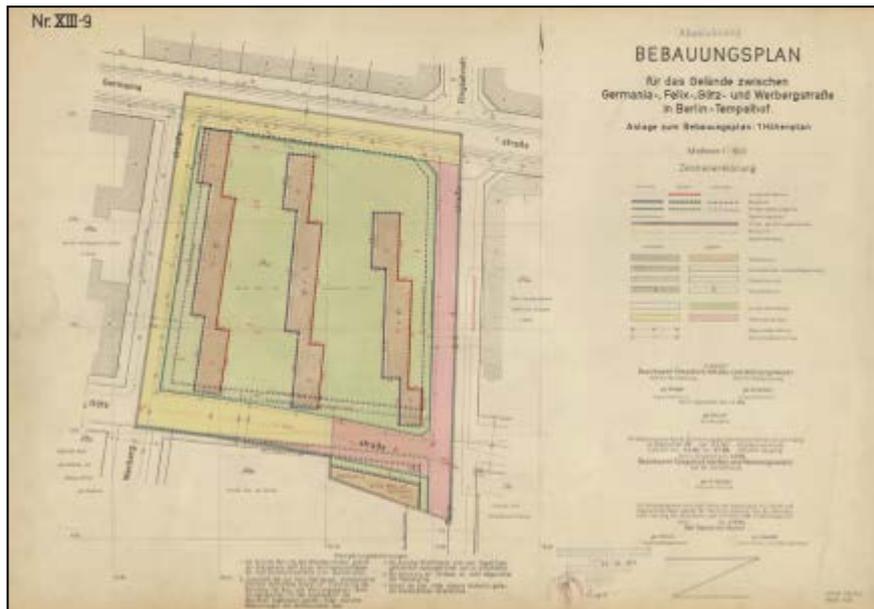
Bebauungsplan XIII-9 (ebda.)
